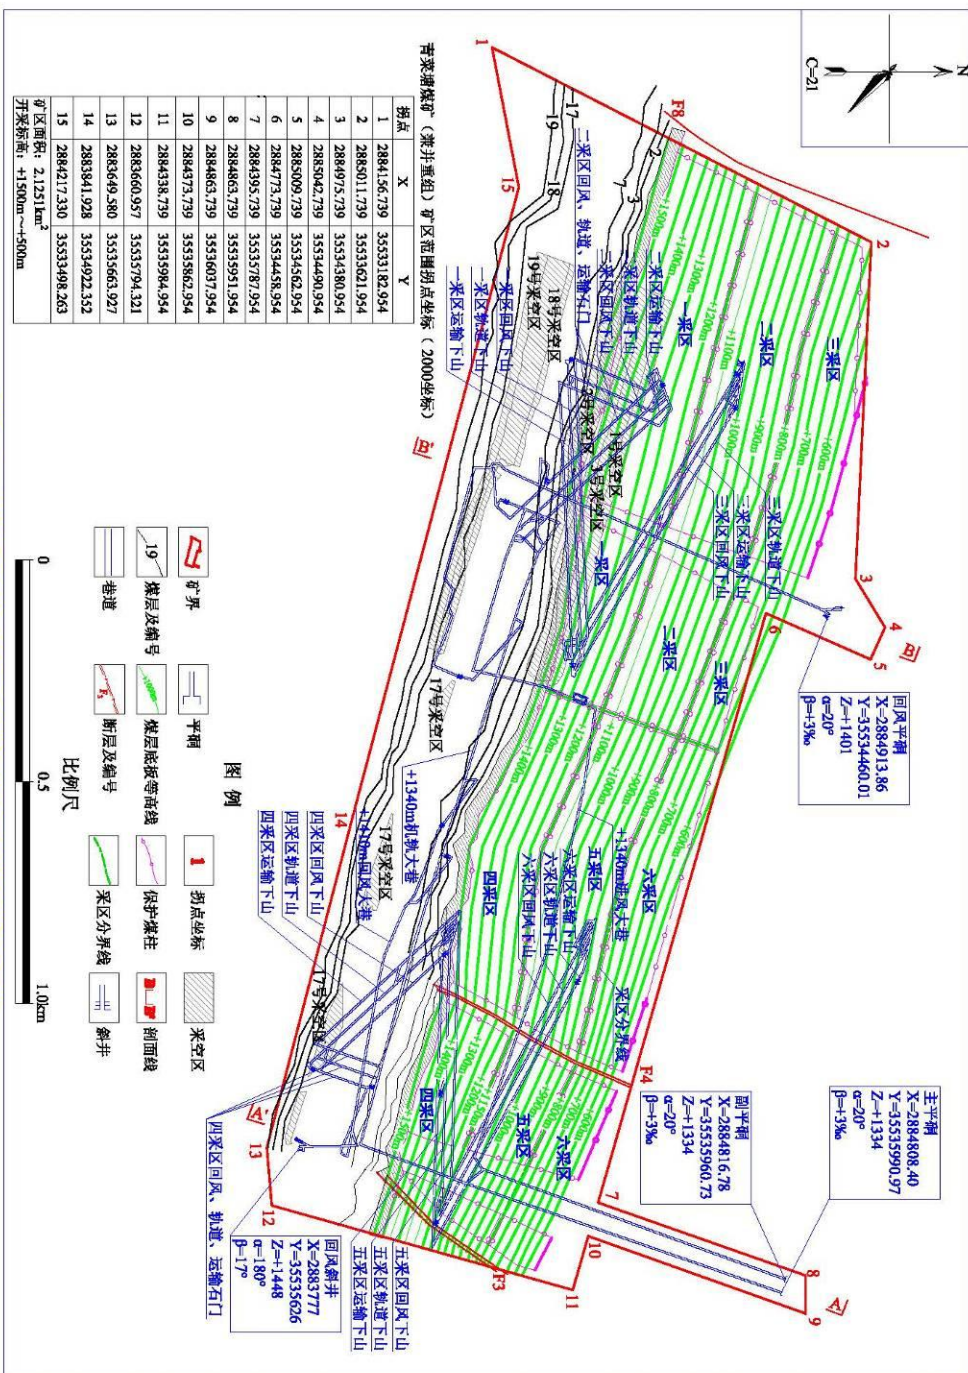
青菜塘煤矿（兼并重组）全井田开拓系统平面图
